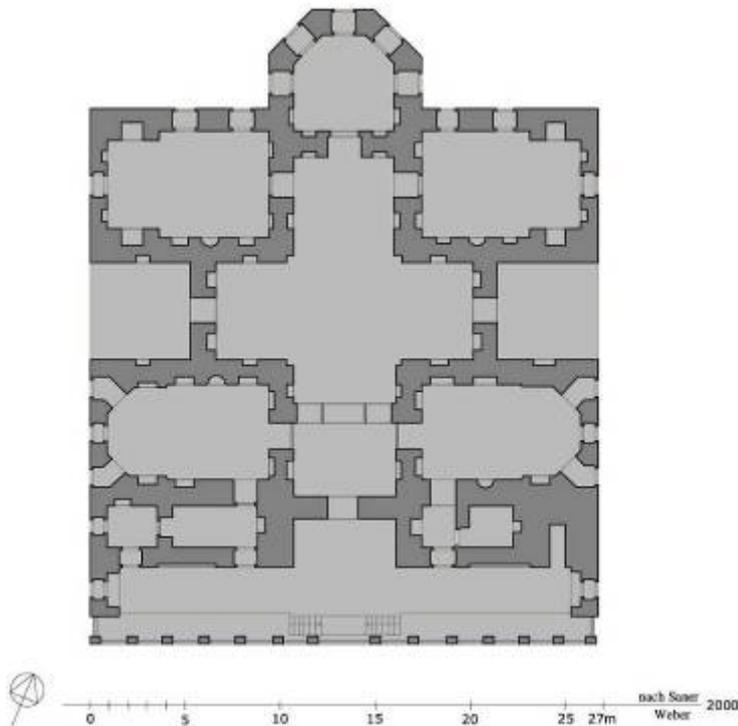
Çinli Köşk (1472-73) in Istanbul, Grundriss EG
